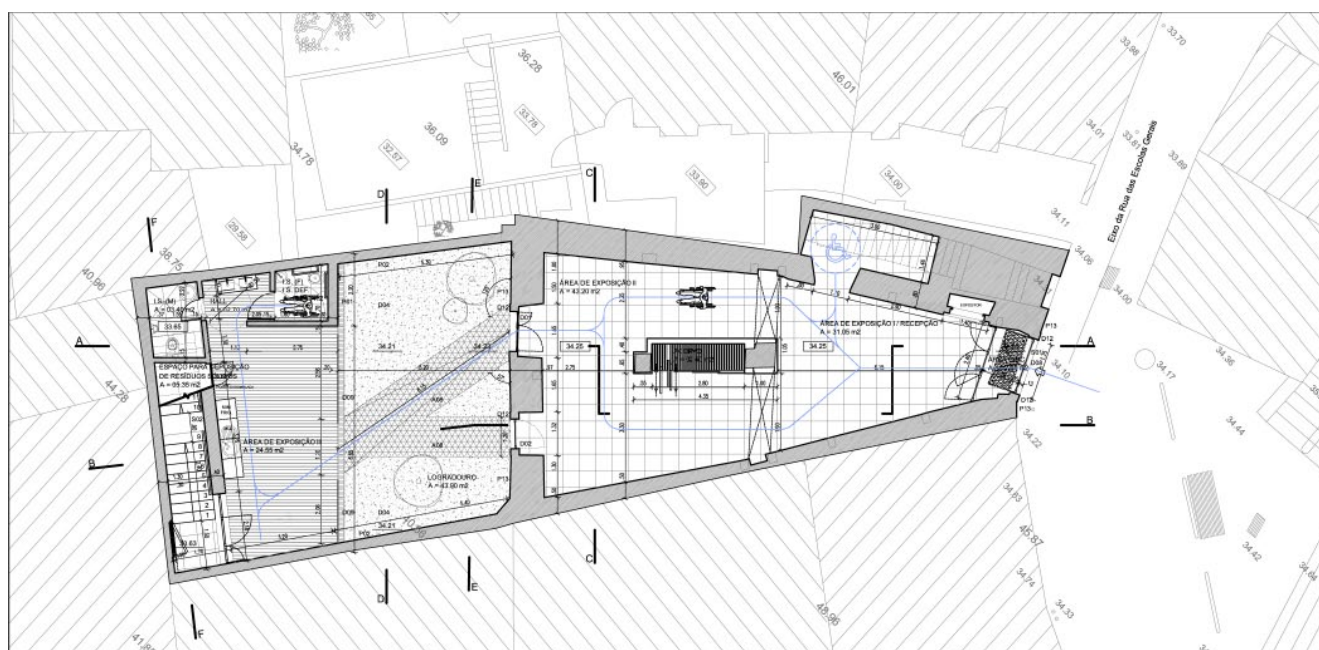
Projeto de Arquitetura. Plano de acessibilidades Piso 0
